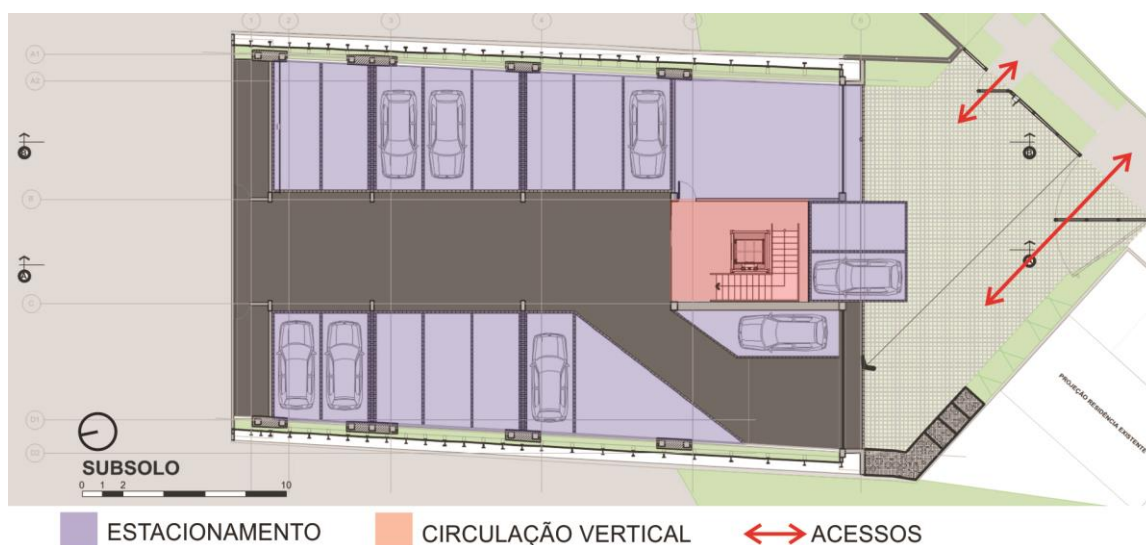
Edifício Oxi – Planta baixa do subsolo.
